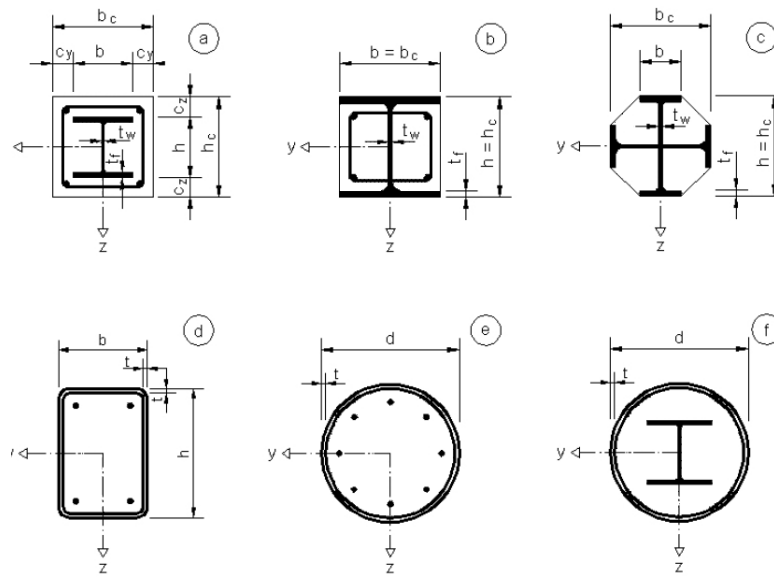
Secções típicas de colunas mistas (adaptado de EC4).
